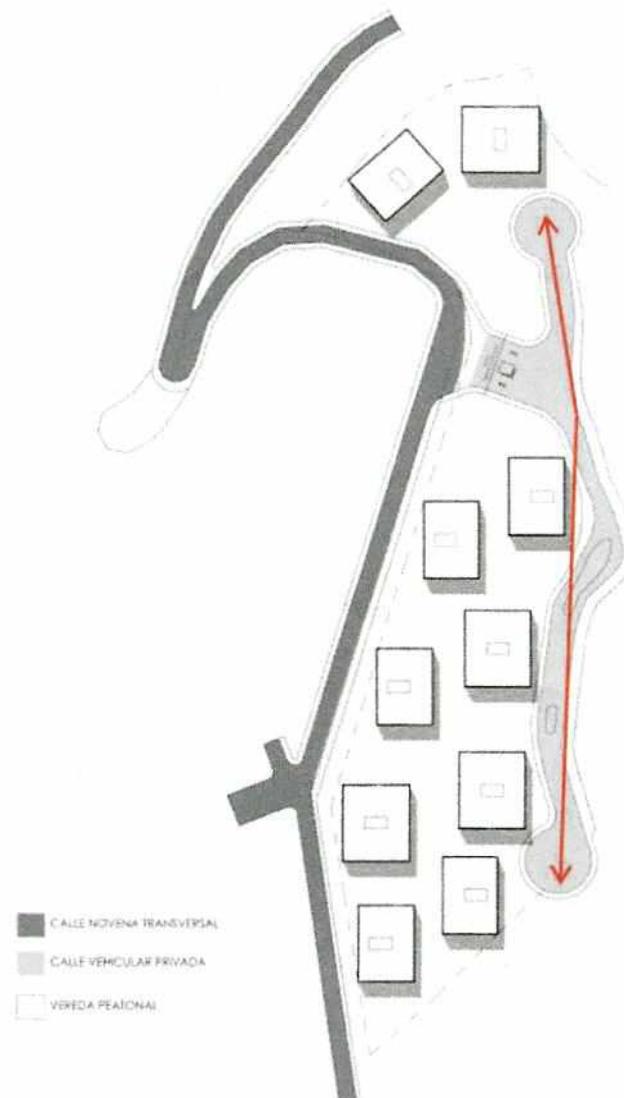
Sistema Vial proyecto Ilaló - Nefol
